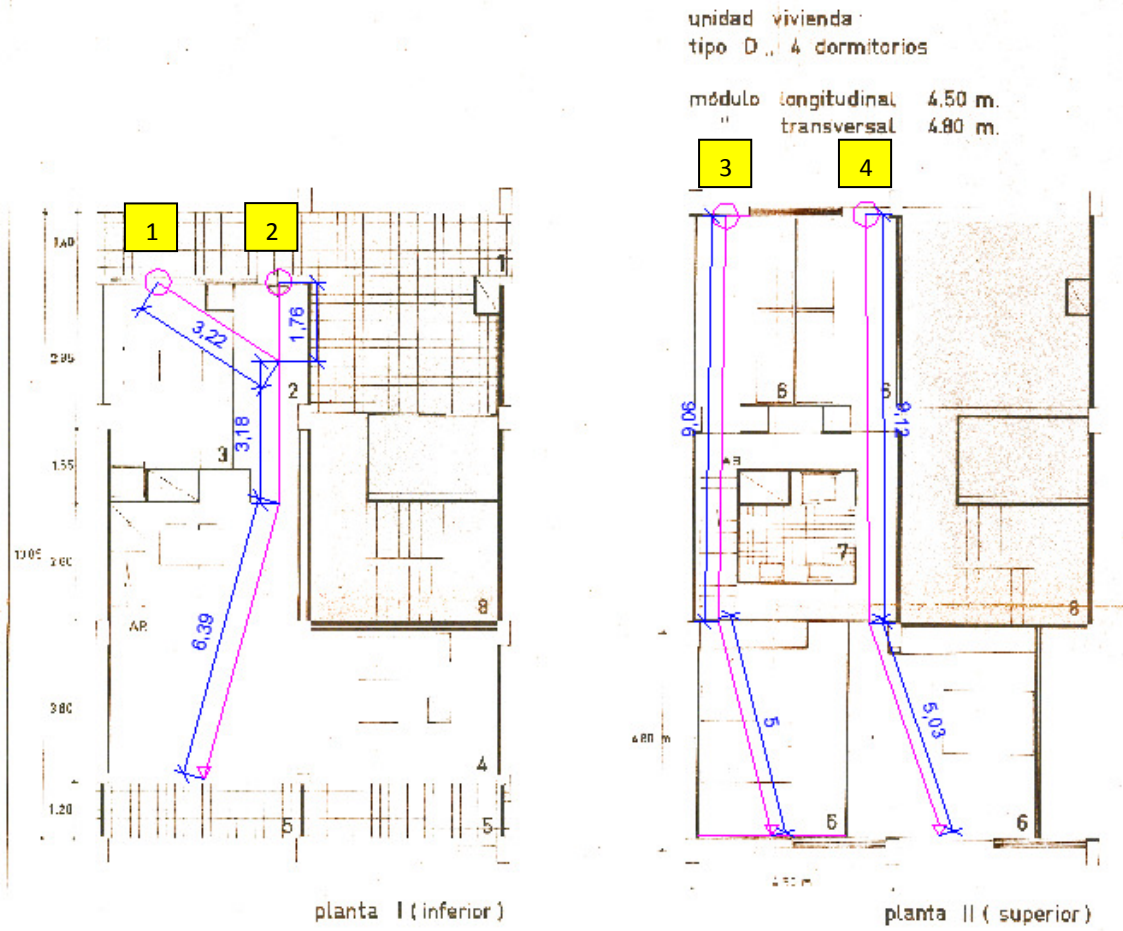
Recorridos del aire entre fachadas opuestas.
